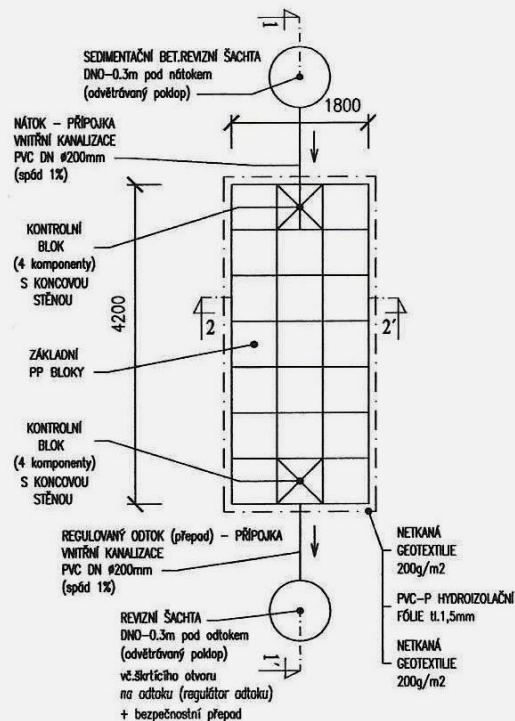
DETAIL RETENČNÍ JÍMKY 1,8x4,2m (PŮDORYSNÉ SCHÉMA a ŘEZ 1-1')
